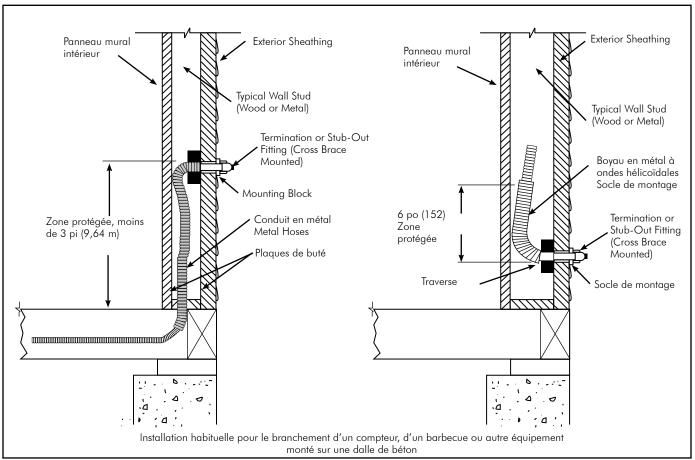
Raccord ou plaque de raccord d'extrémité sur un mur extérieur
